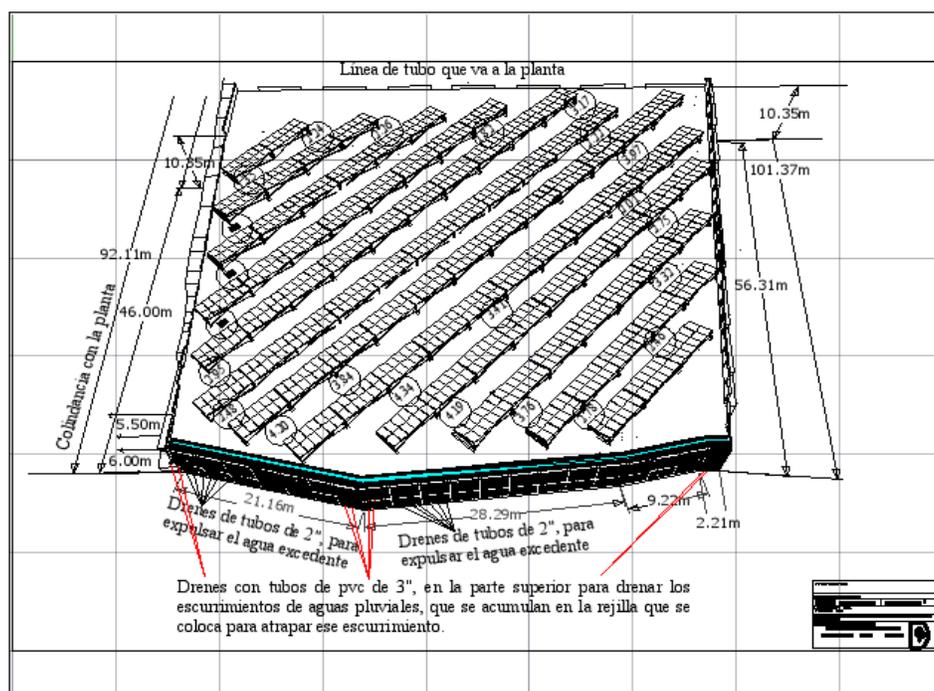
Arquitectónico cotas con los drenes recomendados.
